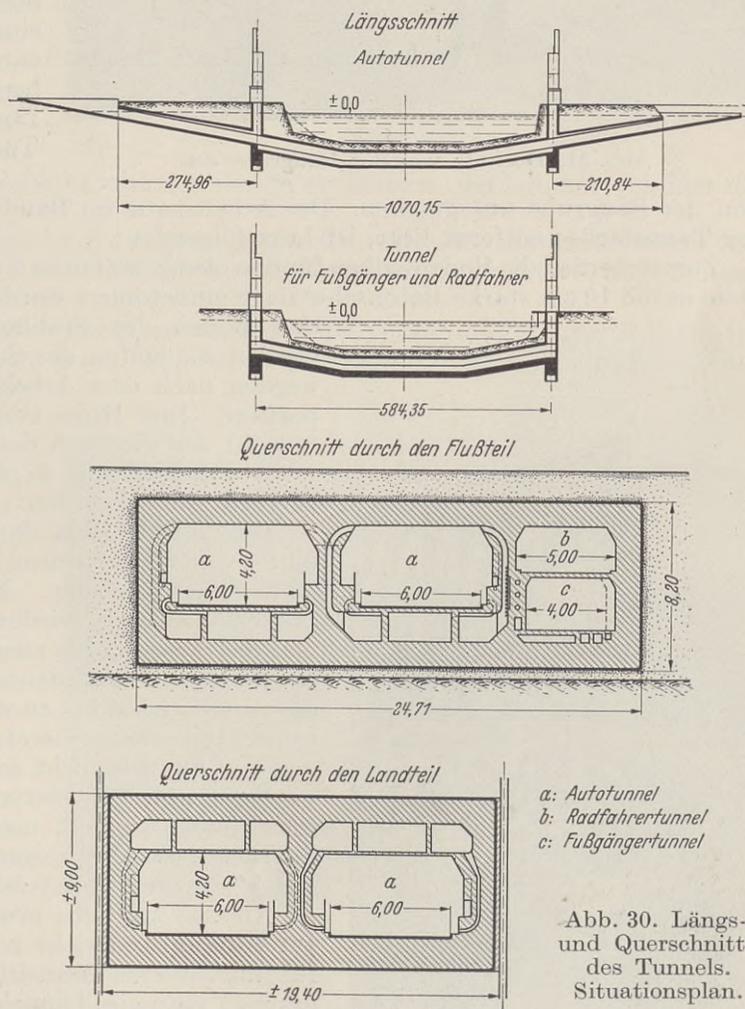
Längs- und Querschnitte des Tunnels. Situationsplan.
